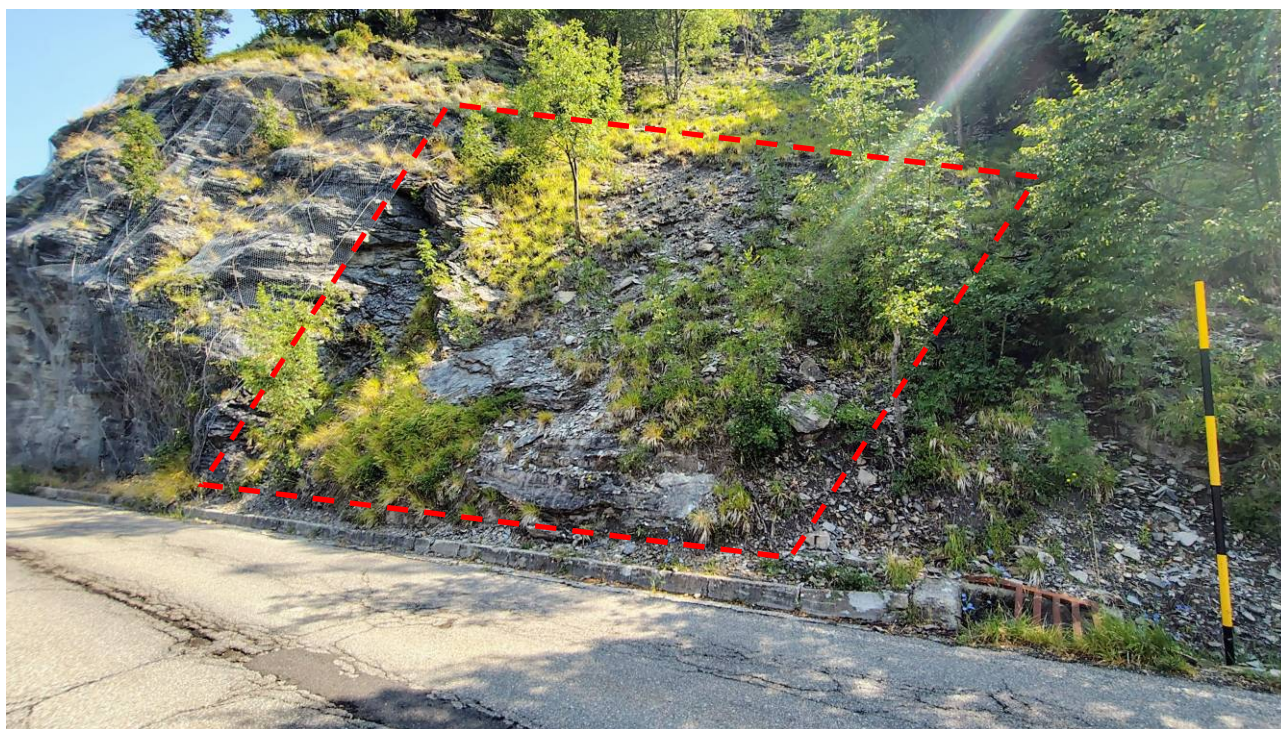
Vista del pendio con evidenziata la porzione che sarà oggetto di rinforzo corticale in continuazione con quello esistente.
